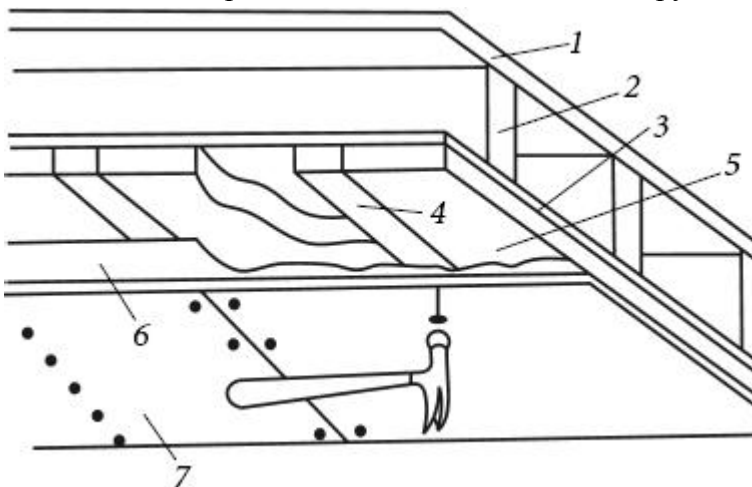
Внутренняя теплоизоляция плоской деревянной кровли: 1) кровельное покрытие; 2) брусья перекрытия крыши; 3) имеющийся потолок (не обязательный слой); 4) деревянные планки; 5) утеплитель; 6) пароизоляция; 7) декоративные панели
